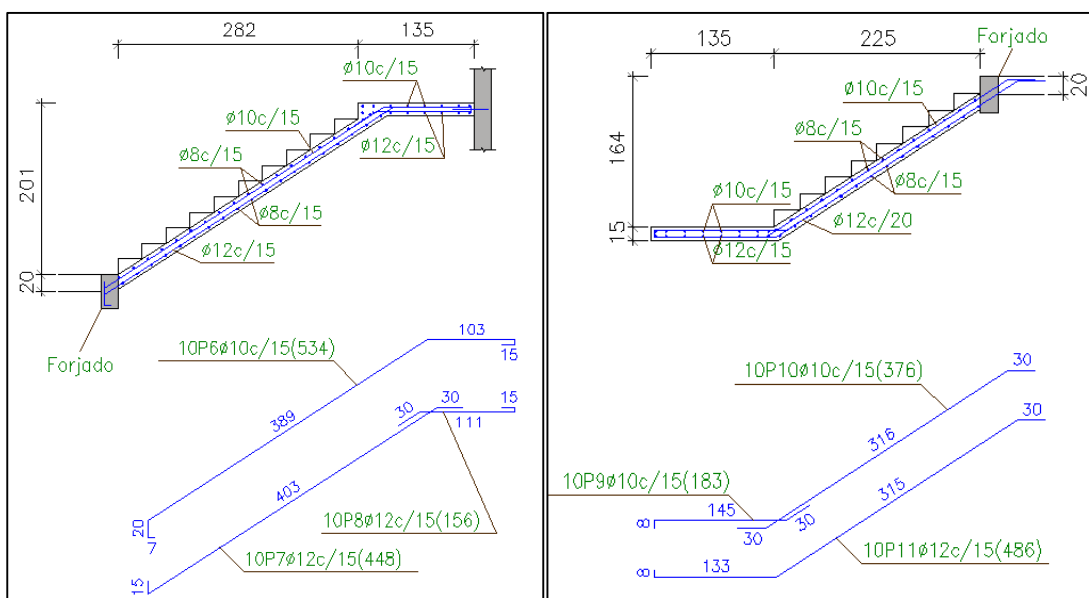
Despiece de Armadura; Elaboración Propia.
